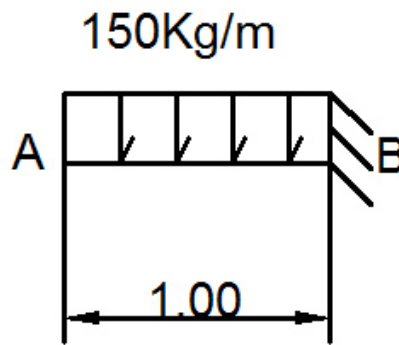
Calculo estructura. Primer TRAMO AB.
